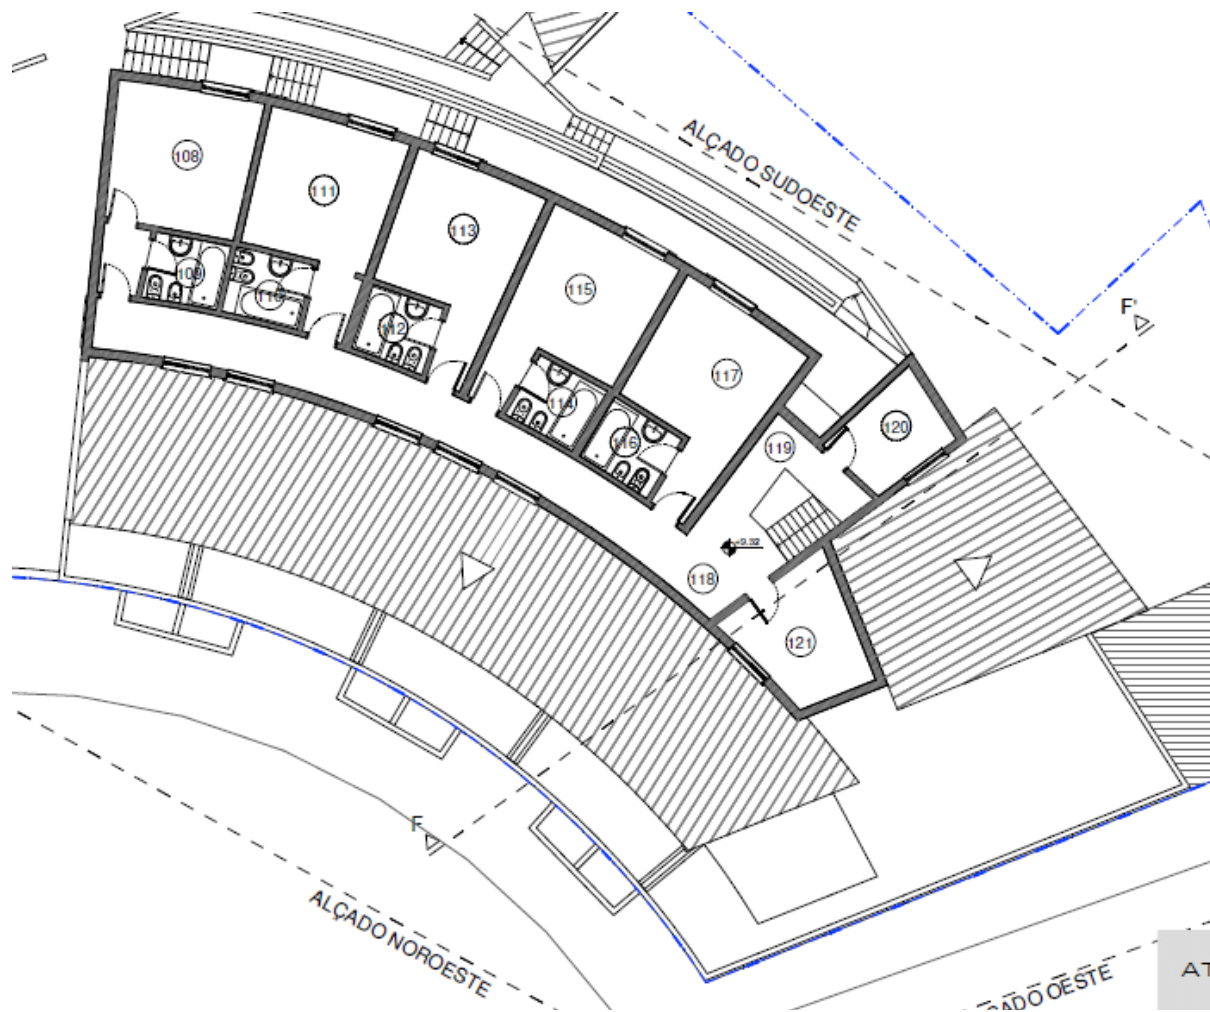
Planta do piso 3 - Edifício existente [Atelier B2, 2016]
